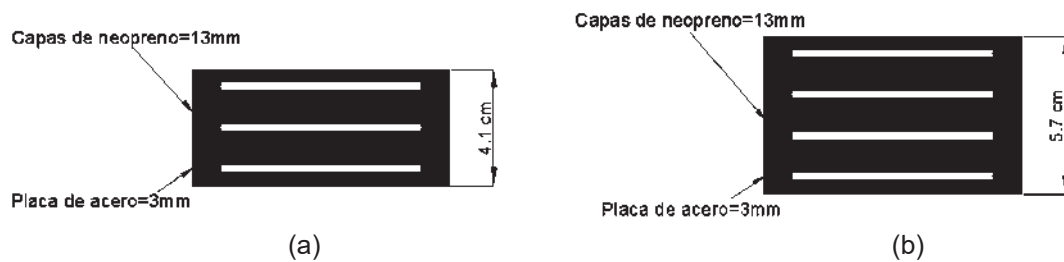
Apoyos de neopreno: a) apoyo fijo b) apoyo móvil.
